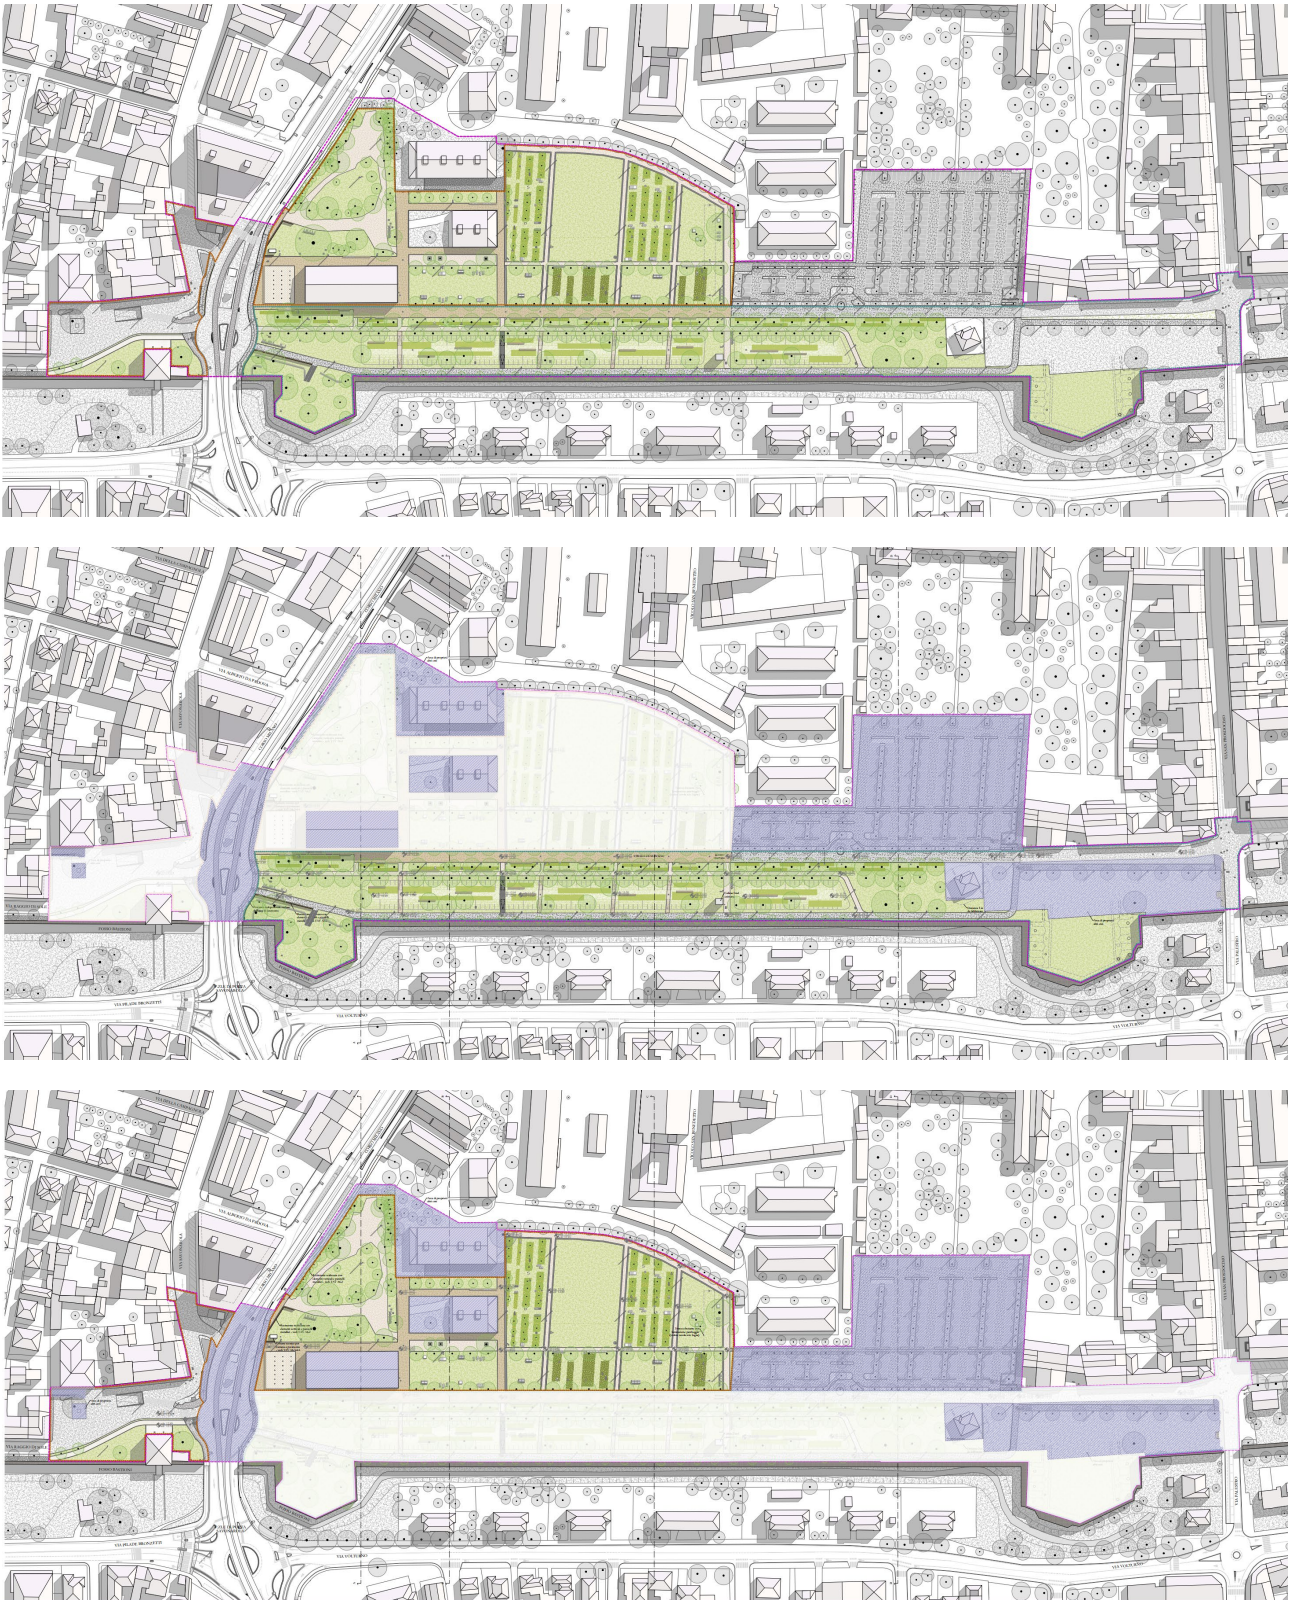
Schema planimetrico del nuovo progetto, comprensivo dei due lotti oggetto di progettazione (in alto), del lotto Riqualificazione Verde (al centro), del lotto Riqualificazione urbanistica (in basso).
